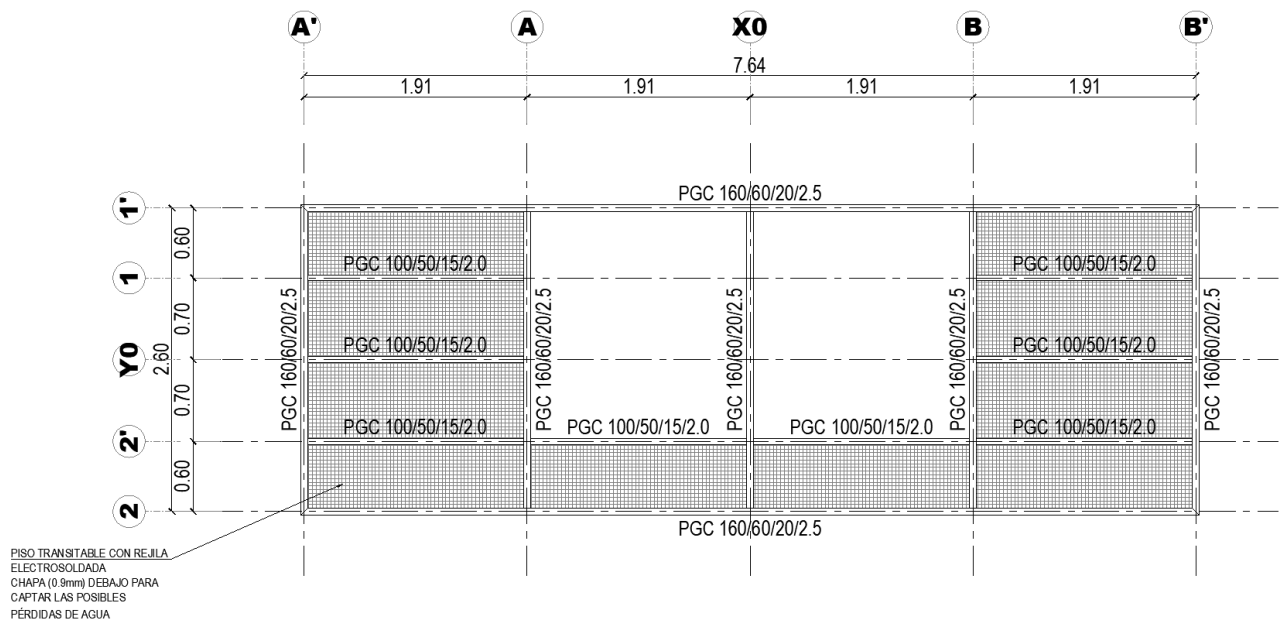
Pasarelas edificios igual altura | Planta +11.50
